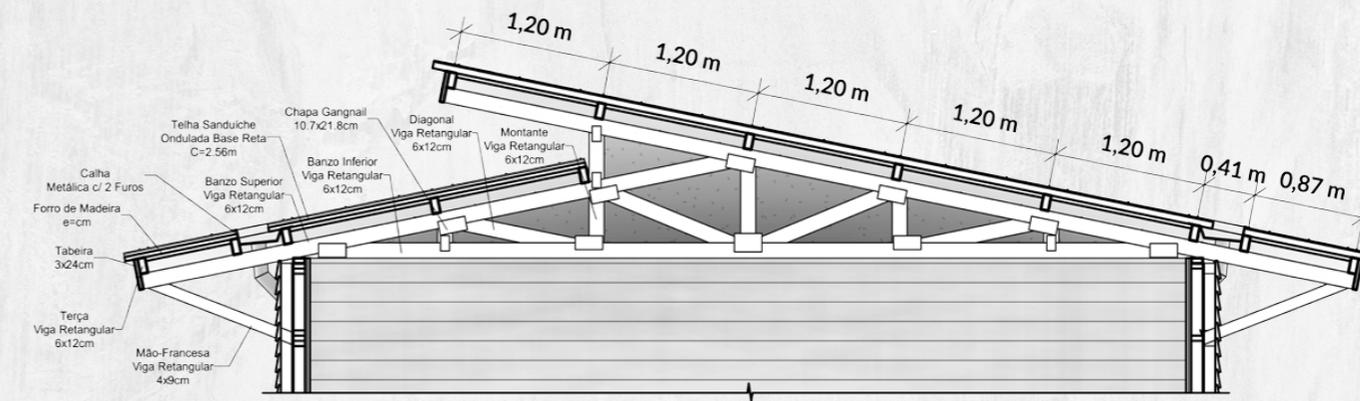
Detalhamento da treliça dos blocos de wood-frame.
